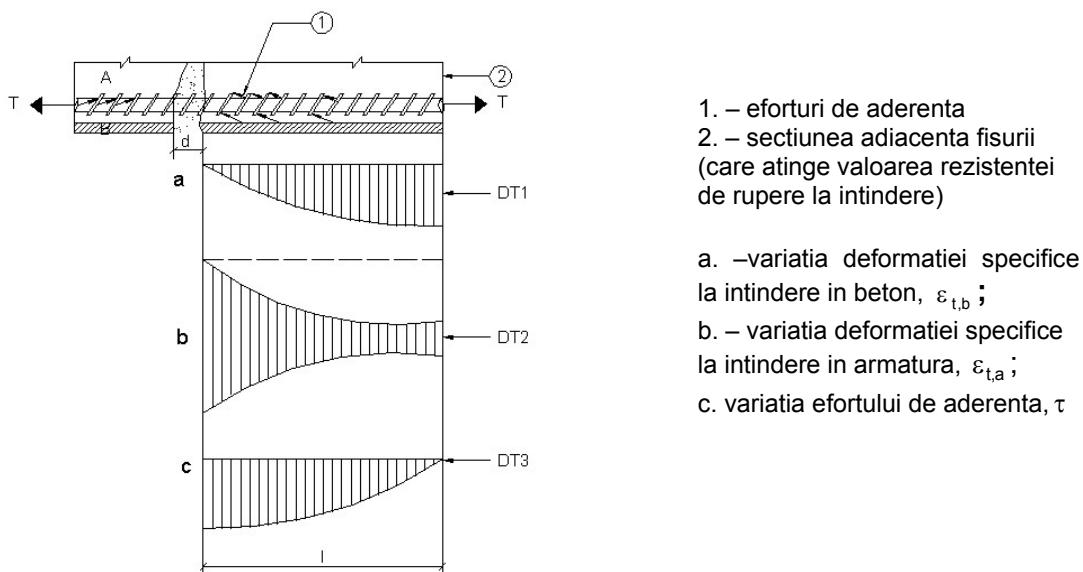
Mecanismul de fisurare a betonului
